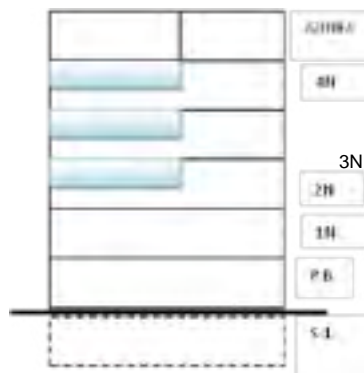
Corte esquemático planta mezzanine, ESDA, París.
